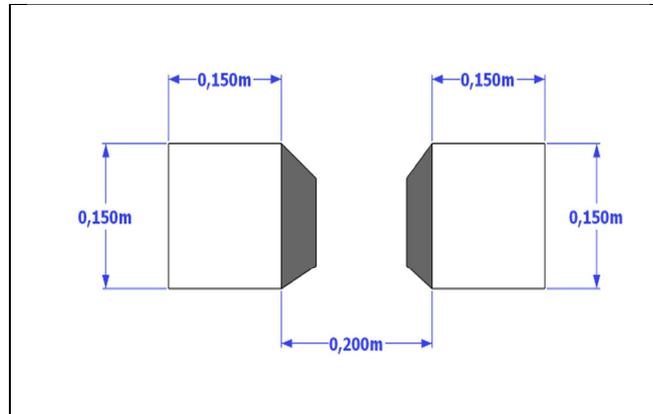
Vista de planta de un par de tabiques para la colocación de un extremo del molde.
